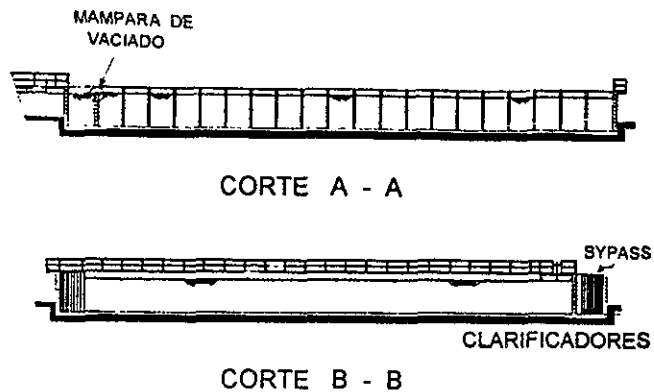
Cortes A - A y B - B del tanque de desinfección
